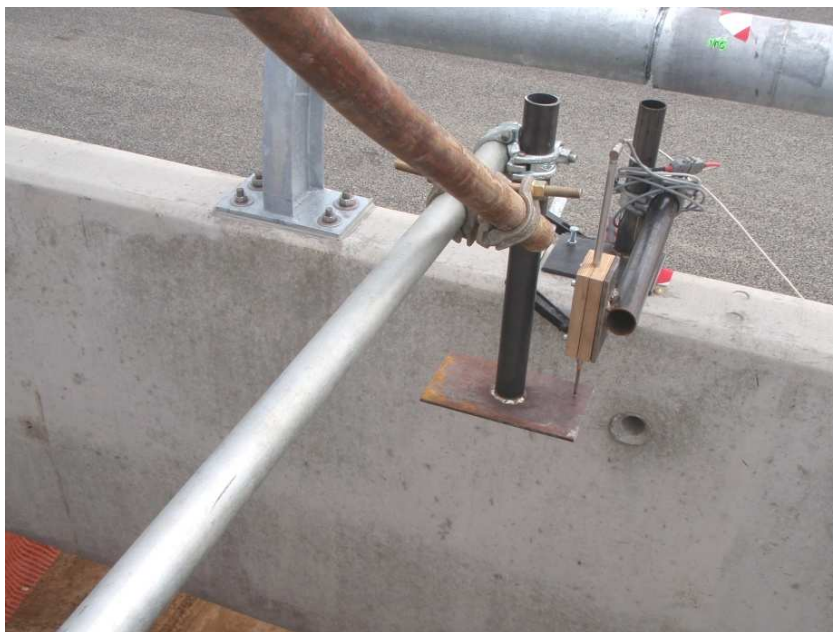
Primer obremenjevanja sosednjih polj levega objekta
